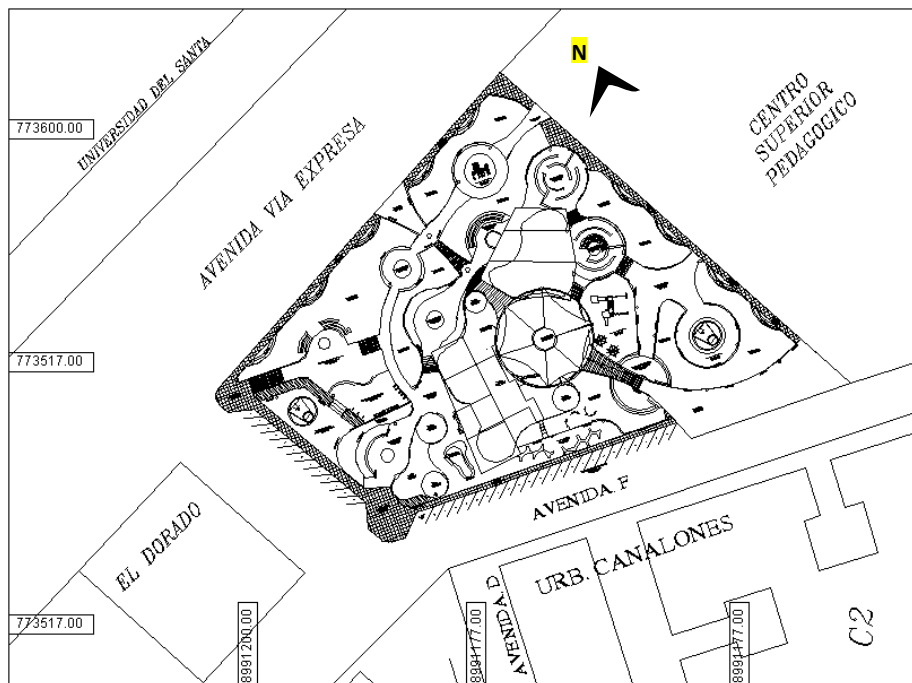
Plano ubicación del terreno. Fuente: Planos Cofopri, Elaboración propia, 2018.
